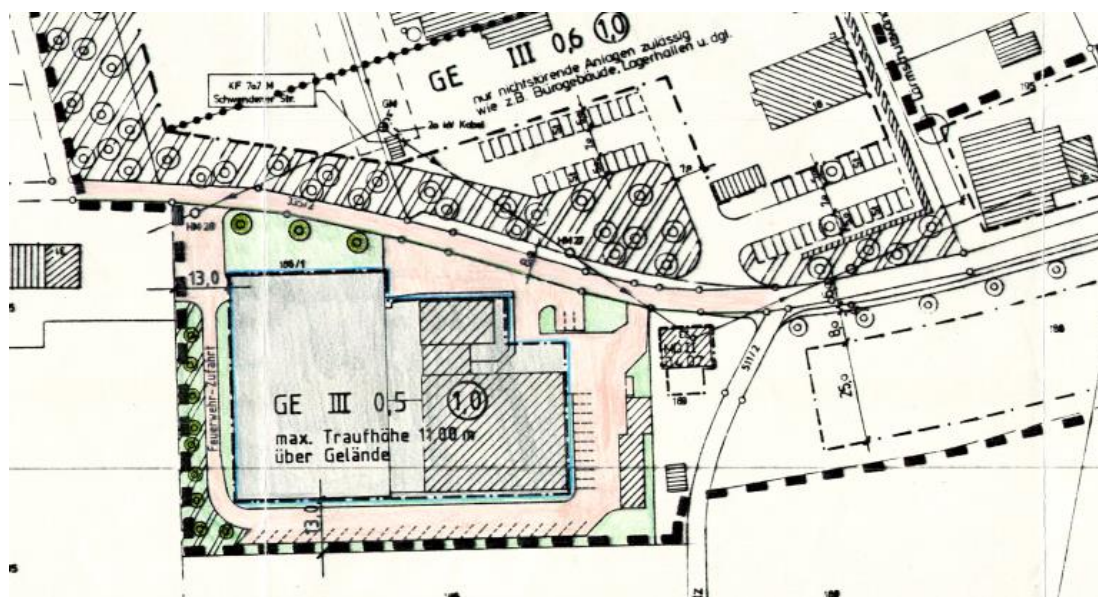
Ausschnitt aus der Planzeichnung, Fassung vom 08.04.2022
